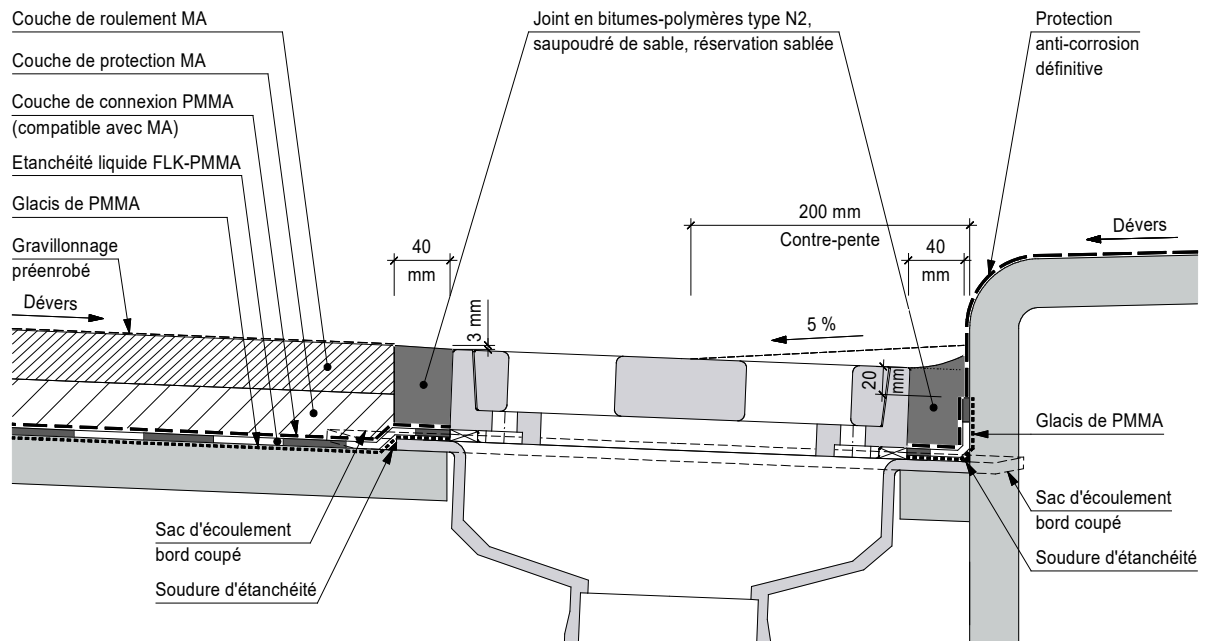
Système d'étanchéité FLK - Raccord aux incorporés en acier ou fonte sur support métallique
